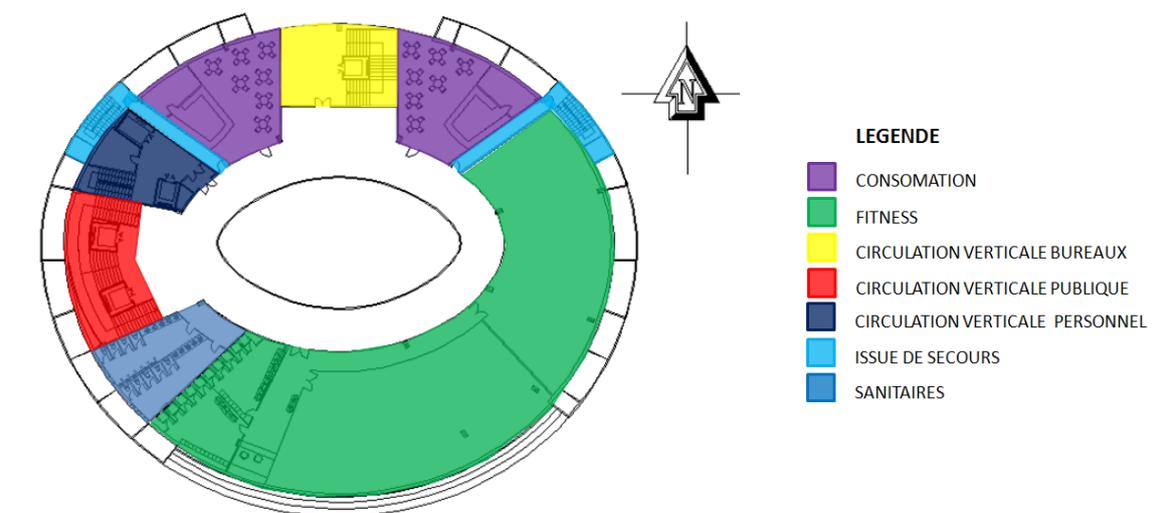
Plan traité du 3ème étage au niveau +14.28.
